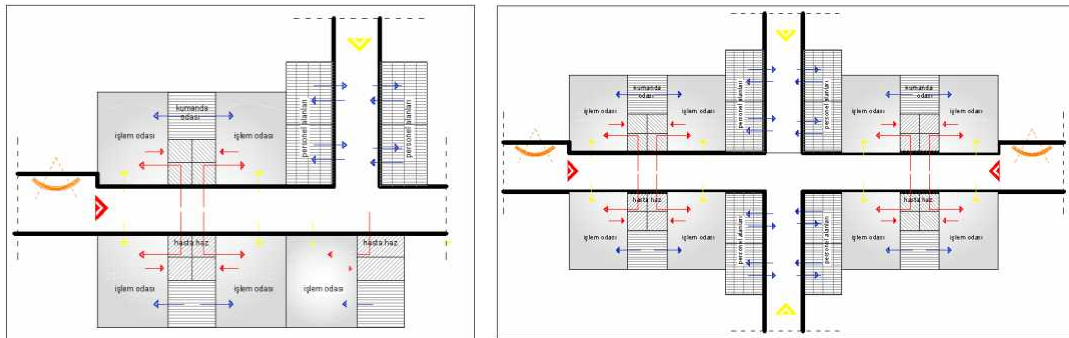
Tek koridorlu Plan Şeması (Yorum:D.Toğan)
